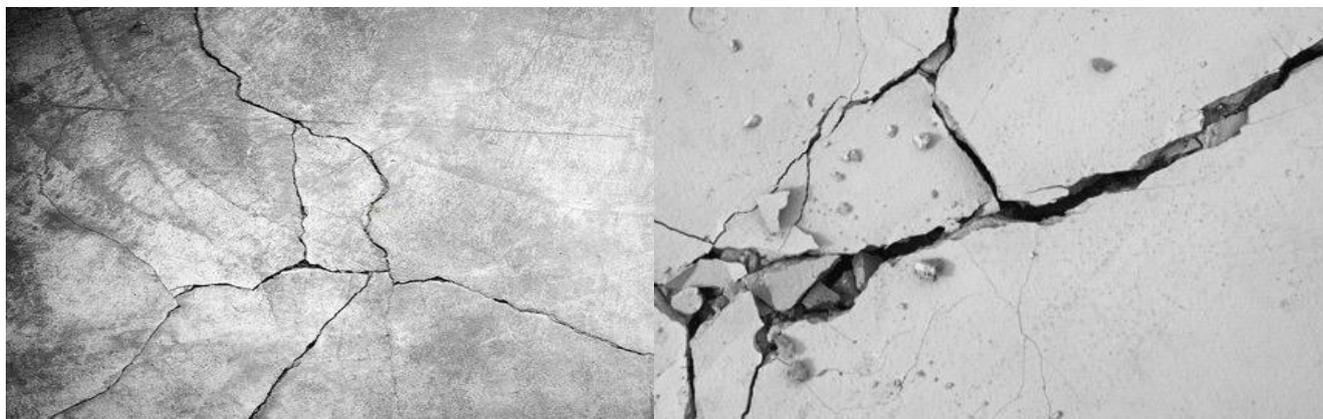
Образование перекрещивающихся трещин в бетоне.
